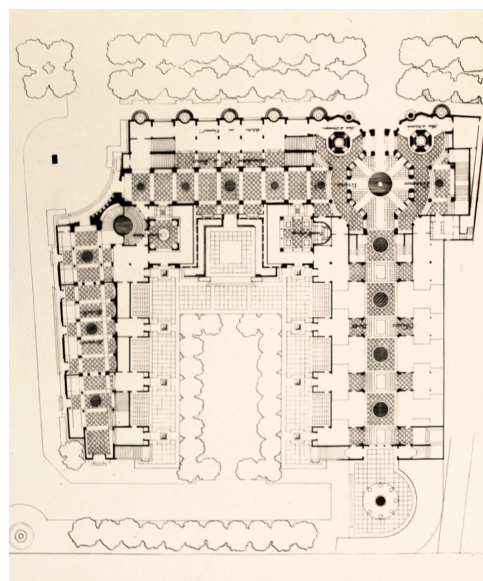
Planta Definitiva del Pavillon de la Céramique, Verrerie et Manufacture de Sèvres.
